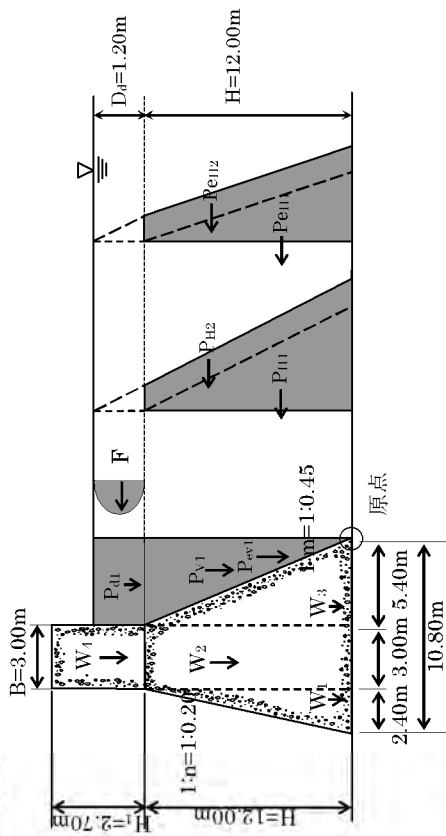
砂防堰堤に作用する力 (断面 (2) : 土石流時)
